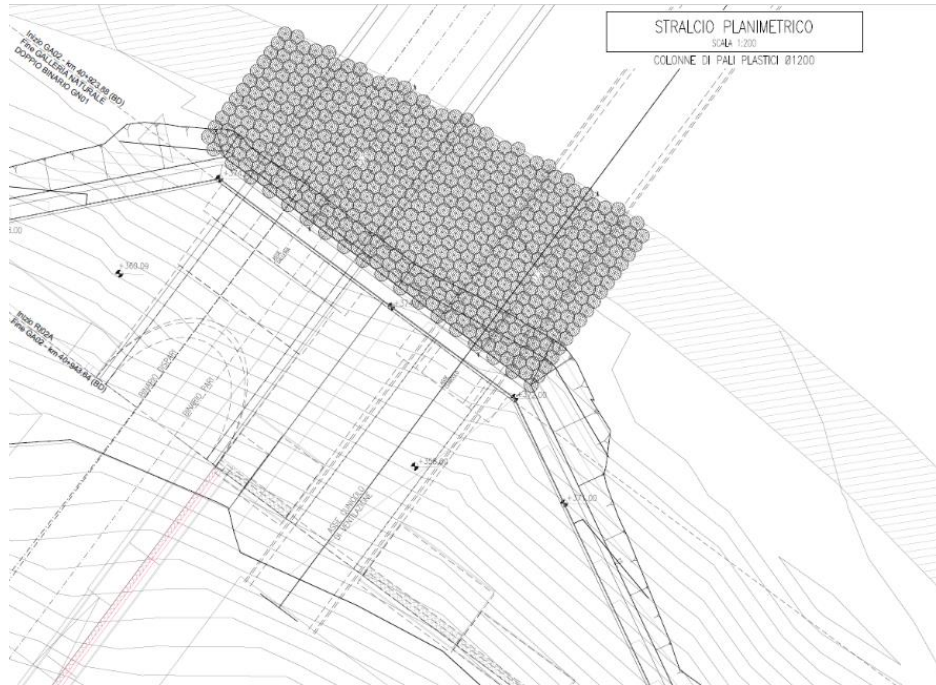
Stralcio planimetria opere di imbocco con ubicazione dell'area interessata dal consolidamento mediante pali plastici .
